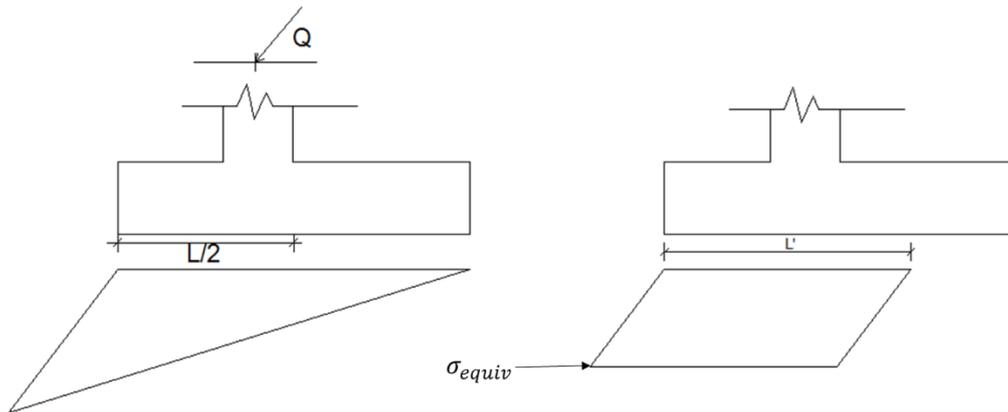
Diagramas de presión del suelo de fundación sobre el muro
